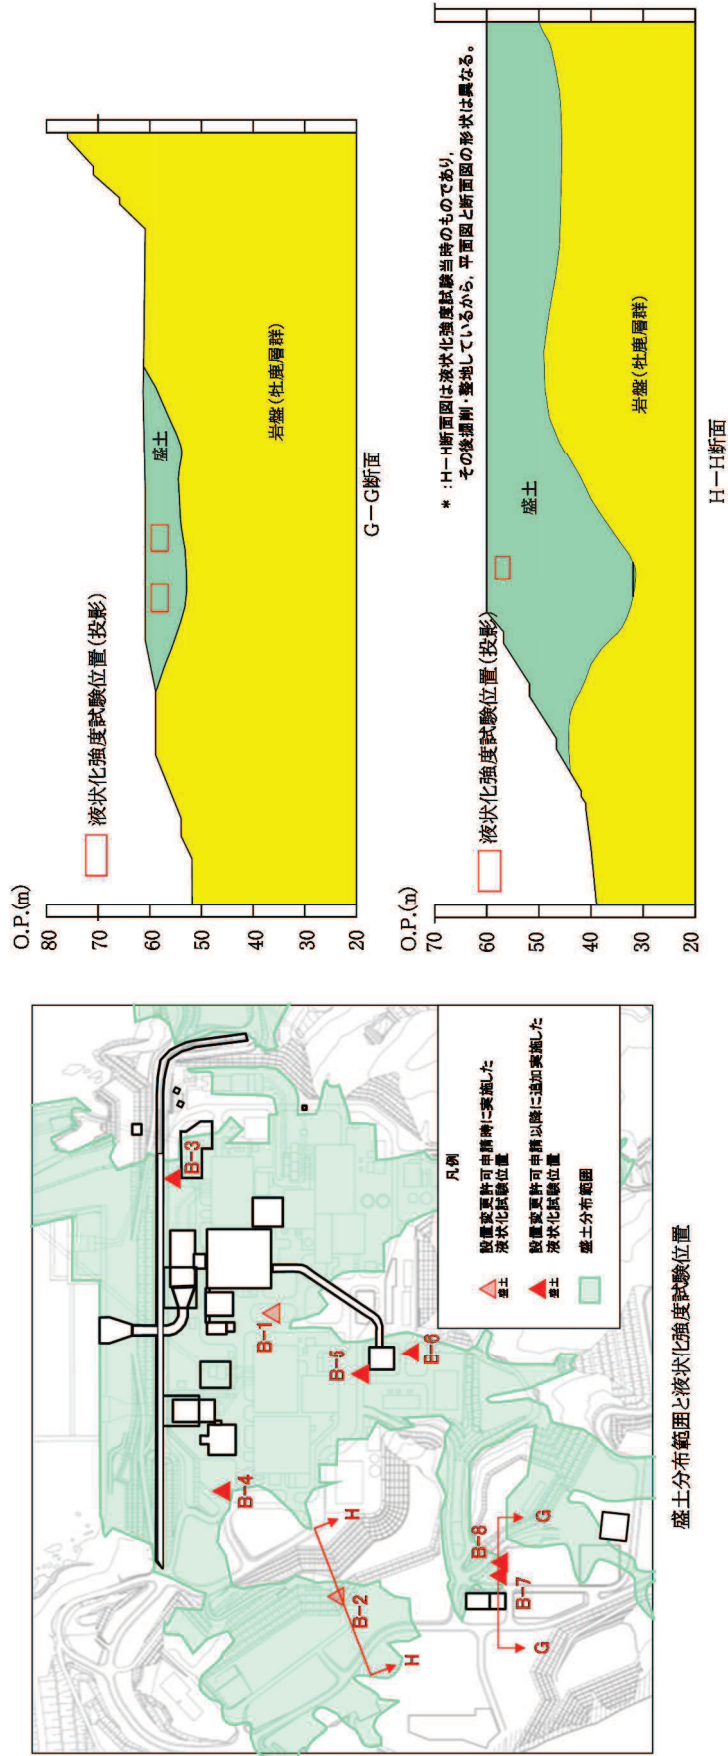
(3) 盛土の液状化強度試験に用いる試料採取位置断面図 (3/3)
